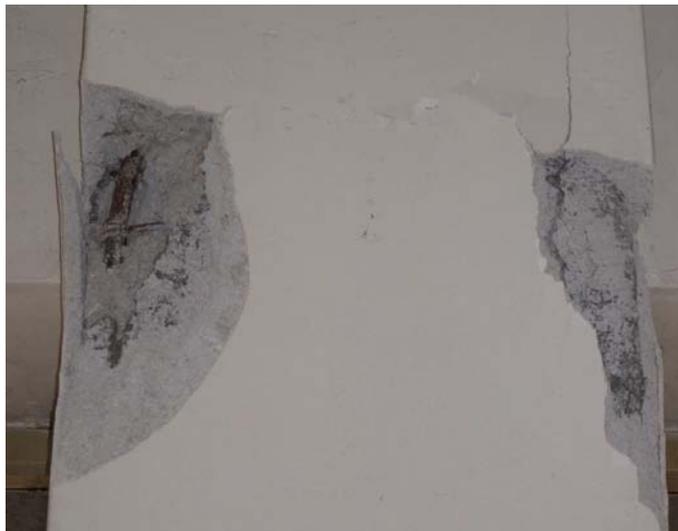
6: Instabilizzazione delle barre di armatura di un pilastro del piano primo.
